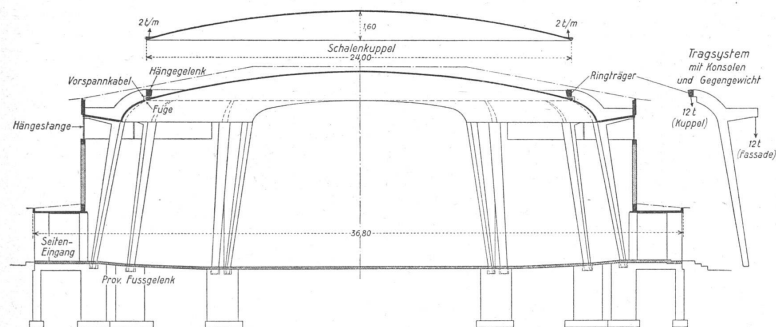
Querschnitt durch die Kirche 1:300, Spannweite der Schale 24 m, Scheitelhöhe 1,6 m | Coupe transversale; portée de la coupole à voile mince 24 m, hauteur au sommet 1.60 m. | Cross section, the span of the shell dome is of 72 feet and its height 5 feet 4"
